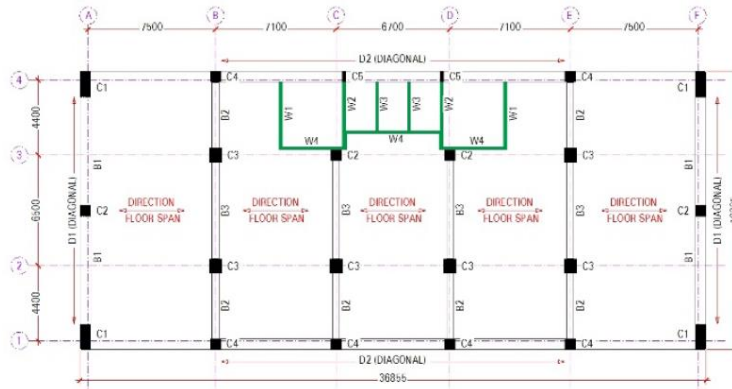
Disposición elementos estructurales en una planta tipo.
